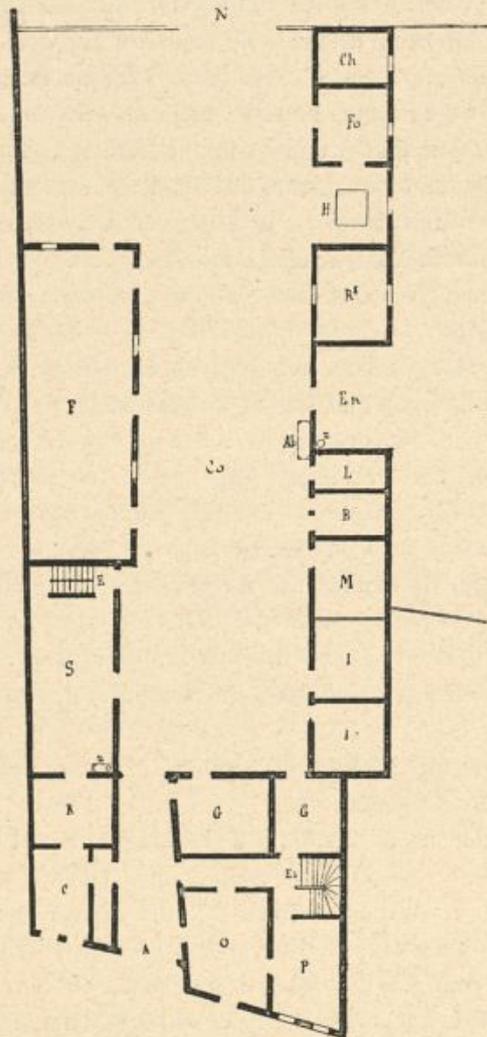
Plan du rez-de-chaussée de l'École de la Guillotière en 1790.
